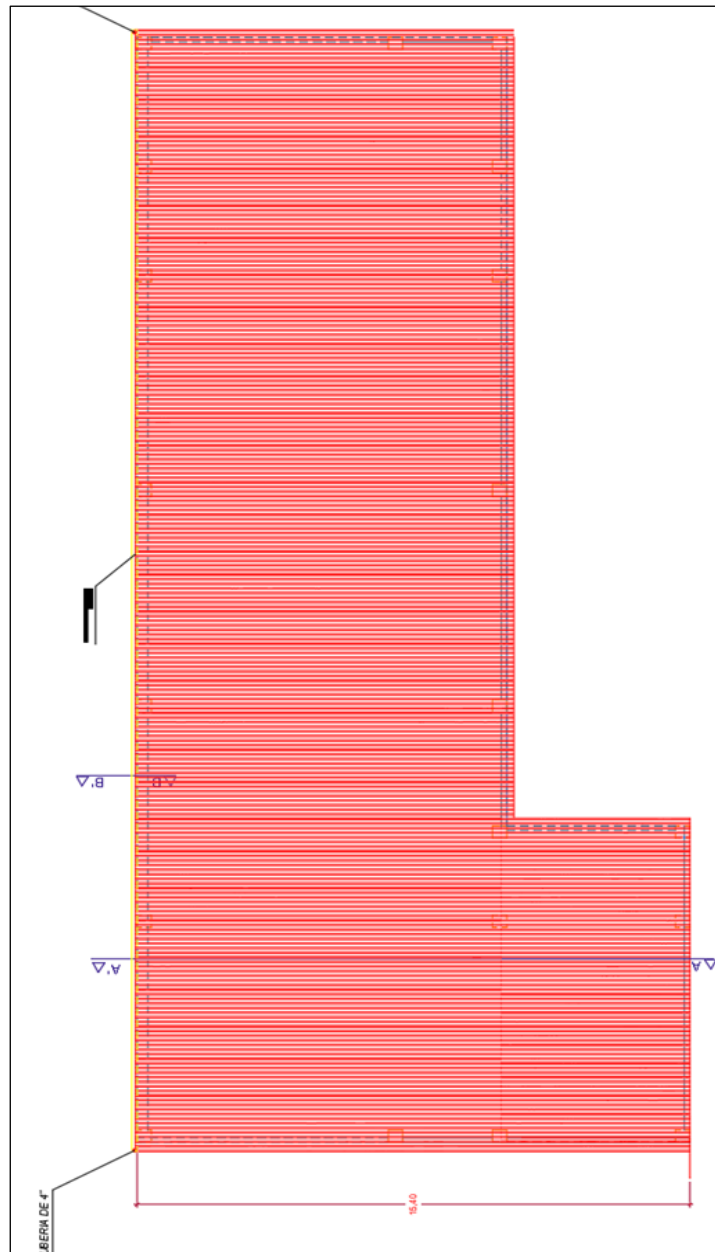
Vista en planta de tejado de la estructura 2 del Centro de Desarrollo Infantil.
